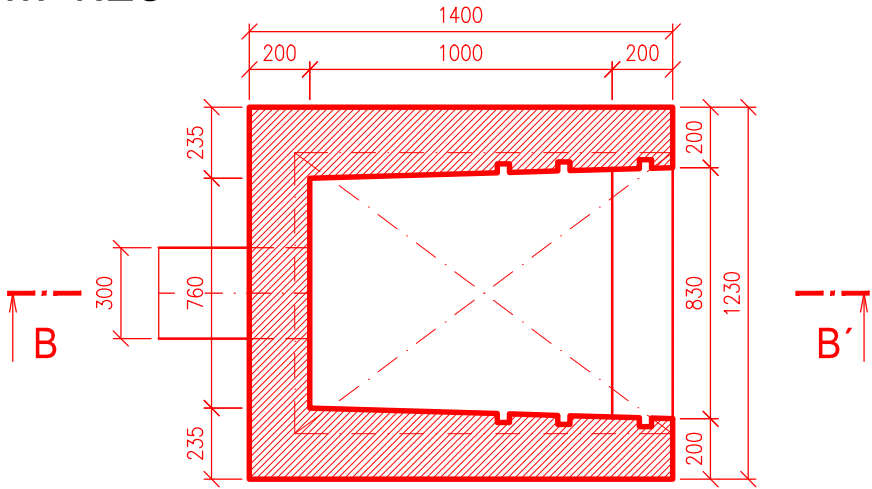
DETAIL ČESLICOVÝCH MŘÍŽÍ
